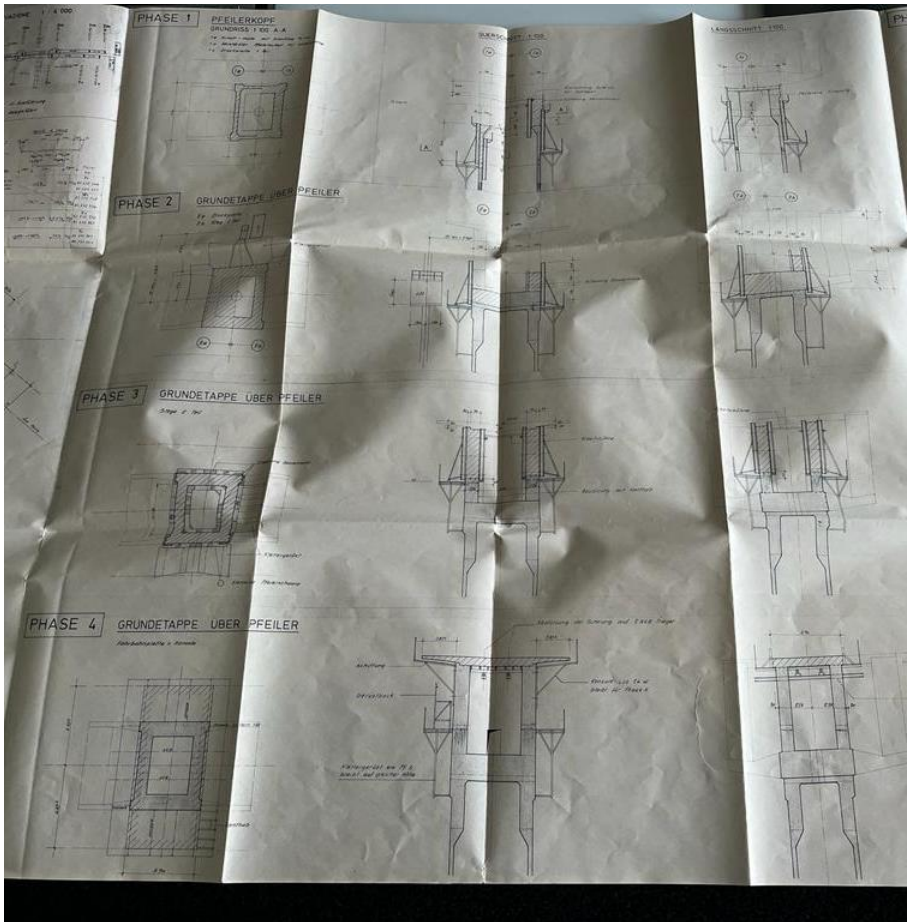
Plan Bauvorgang 1. – 4. Phase
